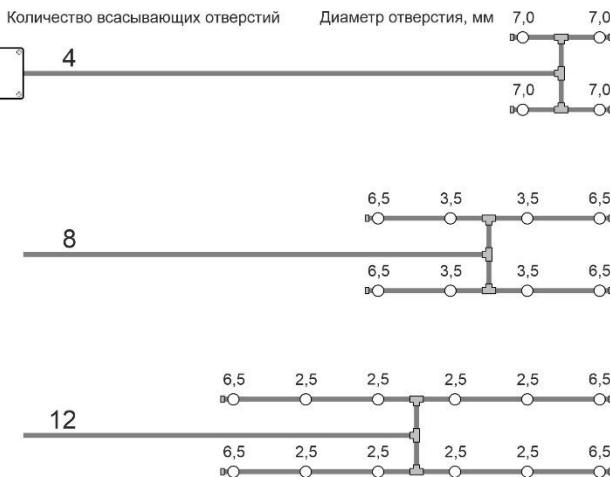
Размер всасывающих отверстий (H-образная топология)
